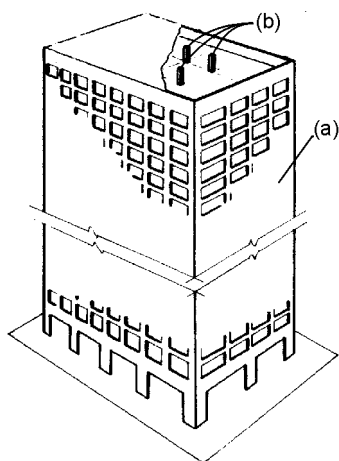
DeWitt-Chestnut Apartment Building w Chicago, USA [52]
